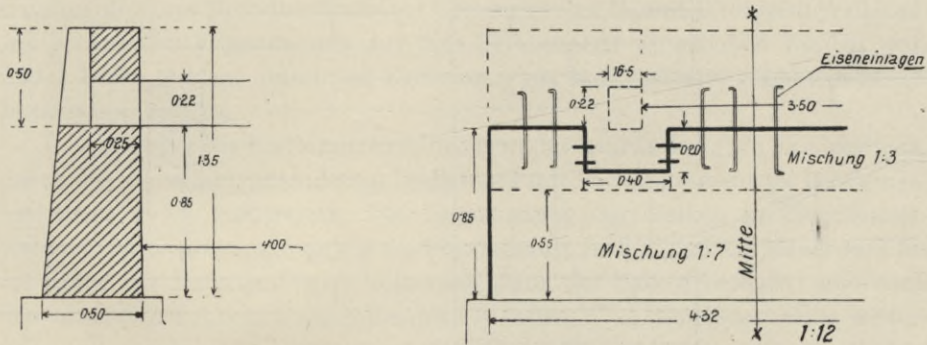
Betonwiderlager der eingemauerten Balkenversuche.
